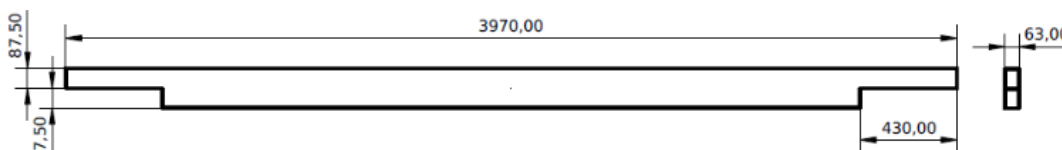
Dimensions en mm d'une poutre à entaillée
